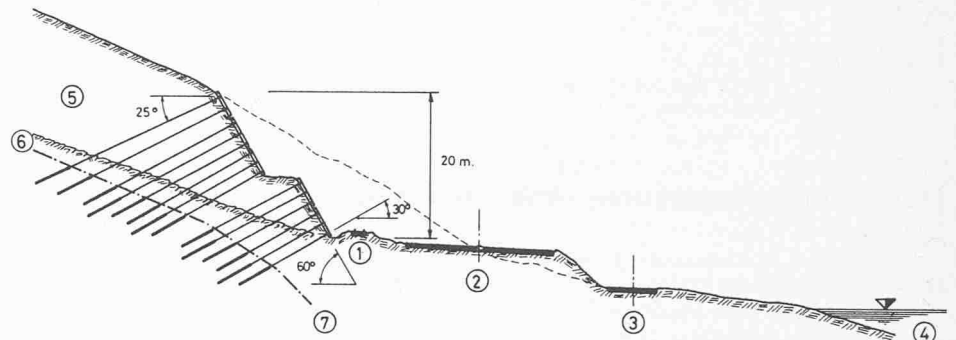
Coupe schématique. 1 Voie de chemin de fer CFF. 2 Autoroute N 8. 3 Route locale. 4 Lac d'Alpnachstad. 5 Eboulis. 6 Rocher. 7 Limite fixée pour le début de la zone d'ancrage des tirants
